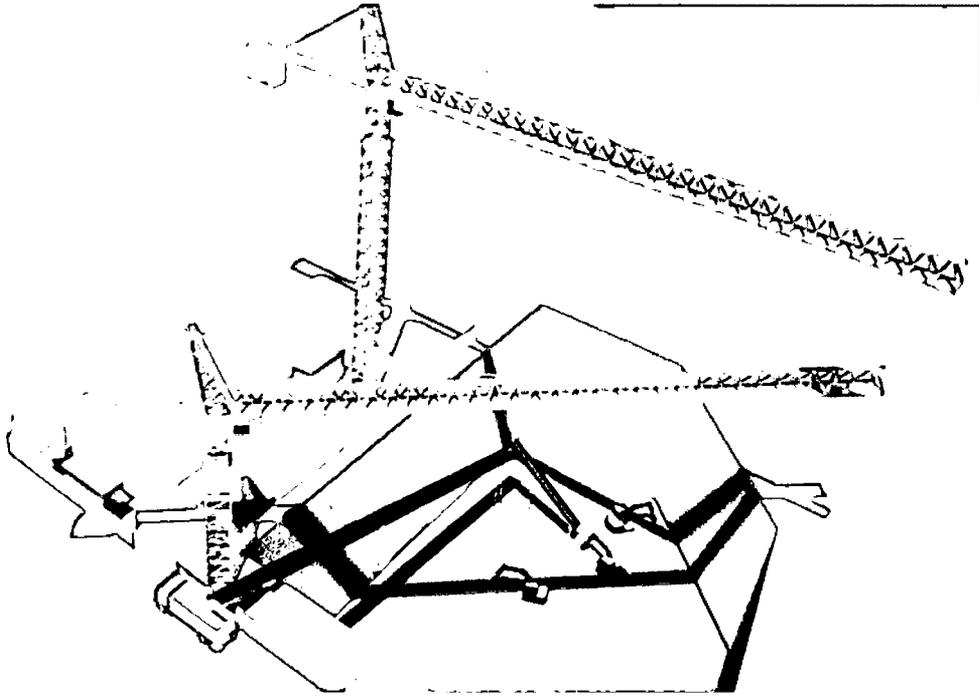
Layout 3D de la etapa de excavación del proyecto
